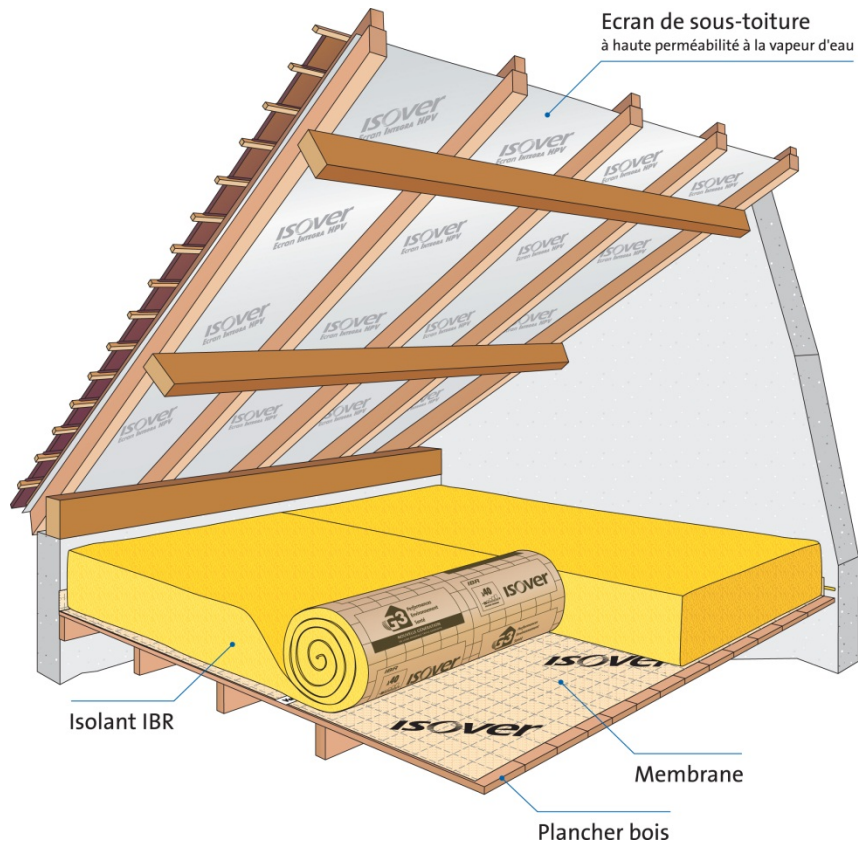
Pose sur plancher de comble perdu : Exemple de mise en œuvre d'isolant en rouleau sur plancher de comble perdu
